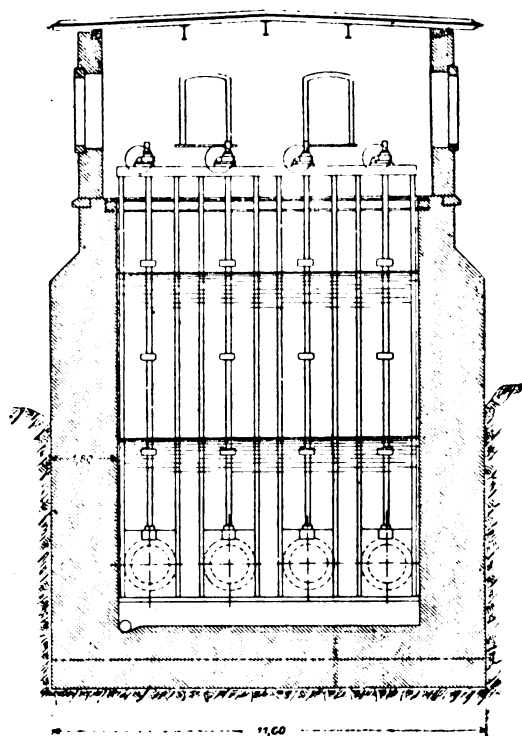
Coupe transversale en élévation du départ des conduites forcées. Échelle 1/200.
